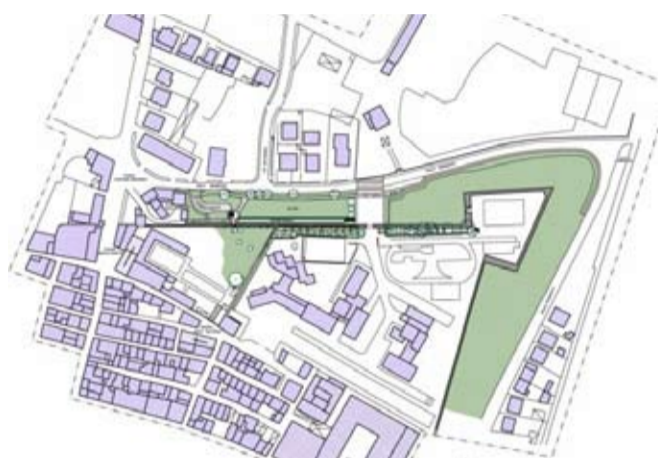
Pianta e sezione progettuale della riqualificazione delle mura di San Sepolcro
